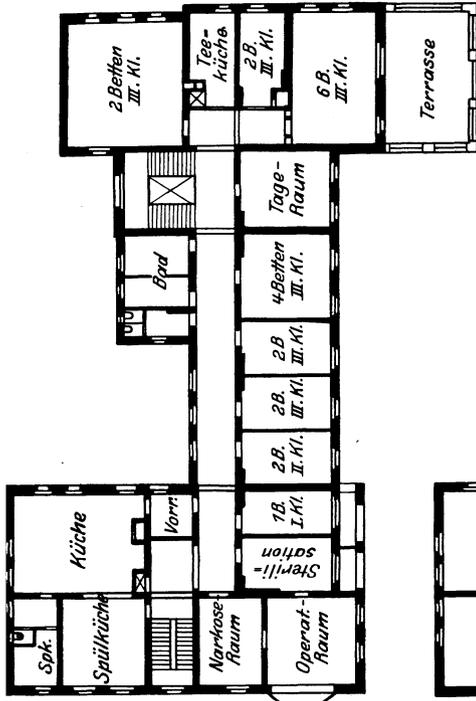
Waidhofen a. d. Ybbs, Kaiserjubiläums-Krankenhaus, 58 Betten, Ober- u. Erdgeschoß.
